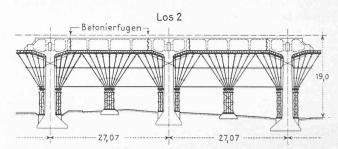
Type d'échafaudage du lot 2. Echelle 1 : 800, Betonierfugen = joints de reprise du bétonnage.
